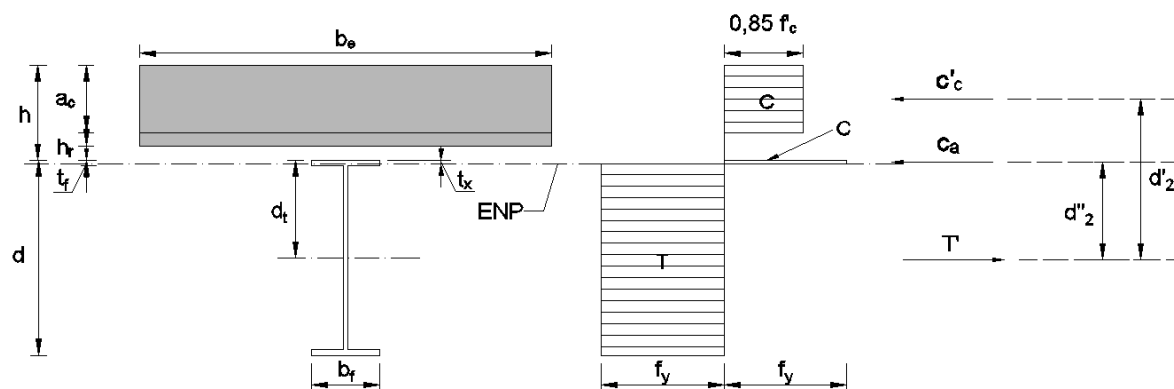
Distribución de tensiones plásticas en la sección compuesta
